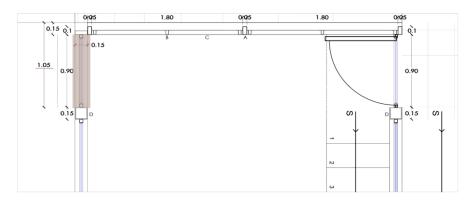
Planta constructiva | Acero tipo cortén Casa RVR
